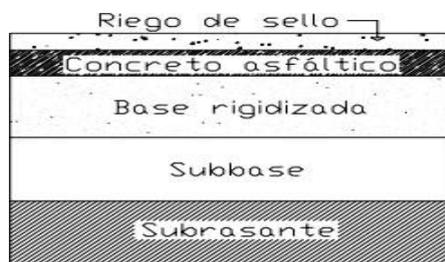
Pavimento Flexible de concreto Asfáltico.
